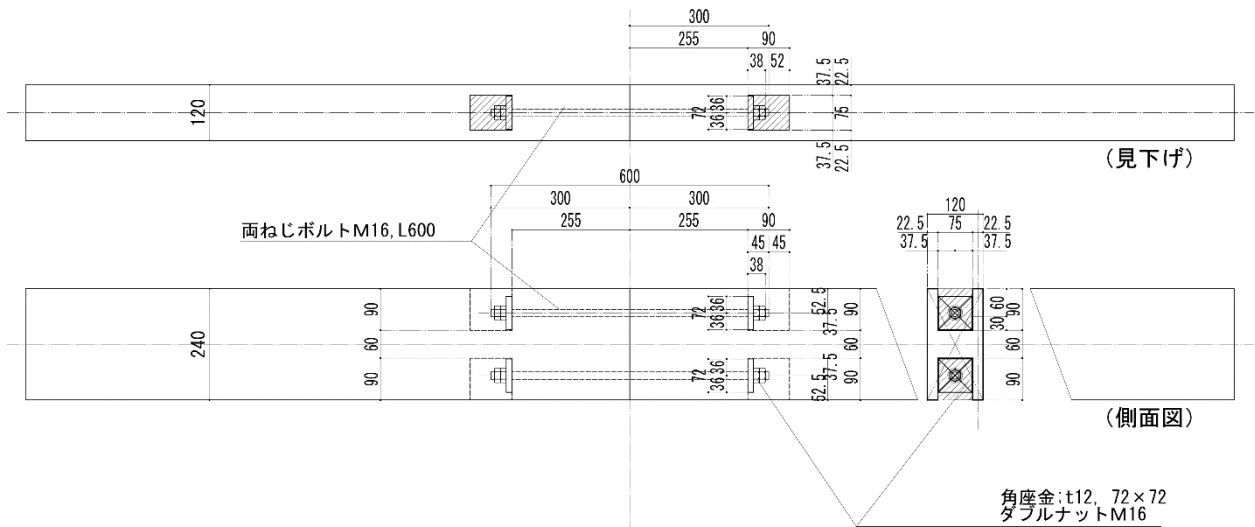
試験体\_No. 12: TBJ-Z600-12/72 試験体
